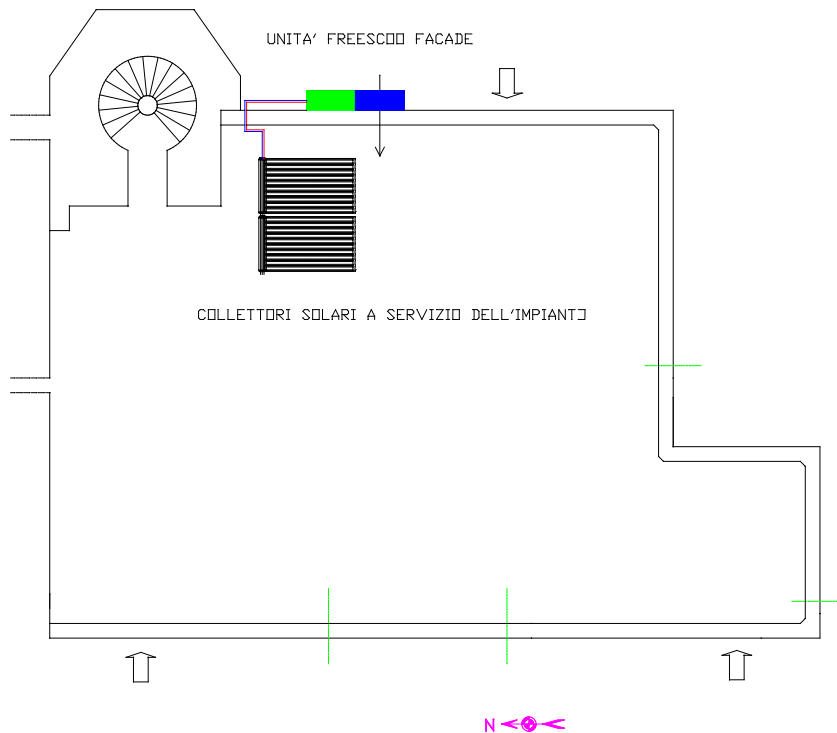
Pianta del lastrico solare con i collettori solari a servizio del sistema *freesco façade
